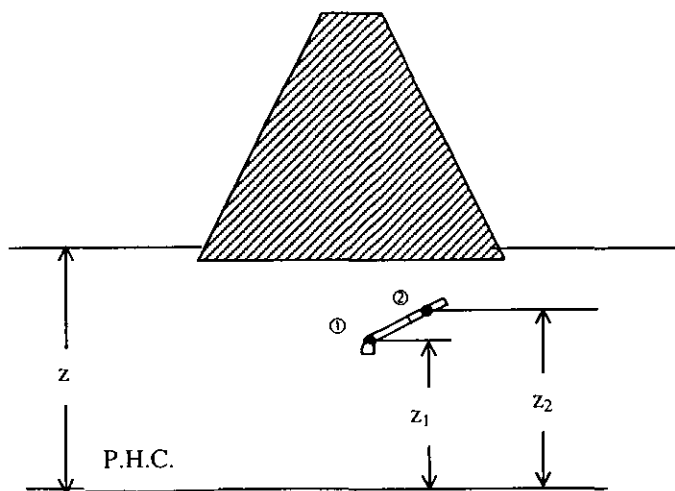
Ubicación esquemática de la galería y los drenes en la cimentación de la cortina
